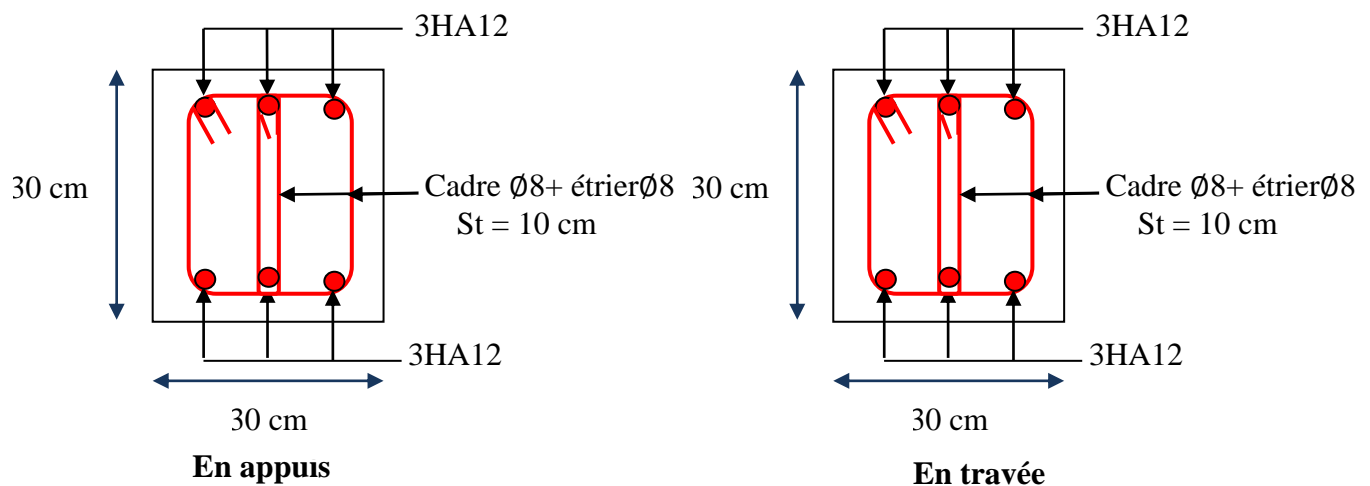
Schéma de ferrailage de la Poutre chaînage
